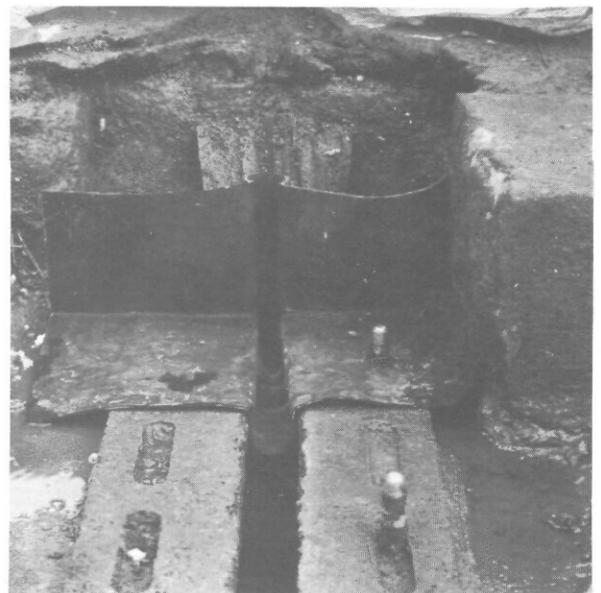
Relevé du dispositif de récupération des eaux mis en place au droit de la bordure de trottoir. Cette pièce est collée à froid à la bavette d'étanchéité régnant sous le joint de la chaussée.
